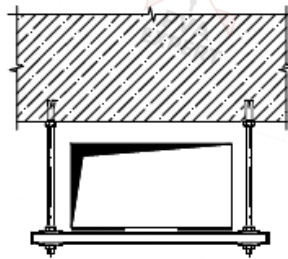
Узел крепления прямоугольного воздуховода к перекрытию
